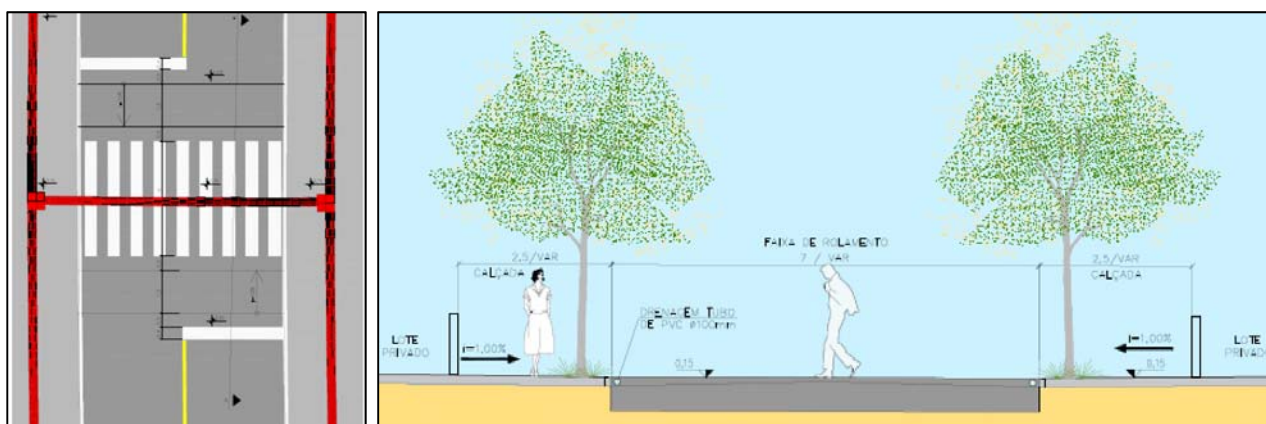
Desenho Esquemático da Planta e Seção Transversal da Passagem Elevada de Pedestres.
